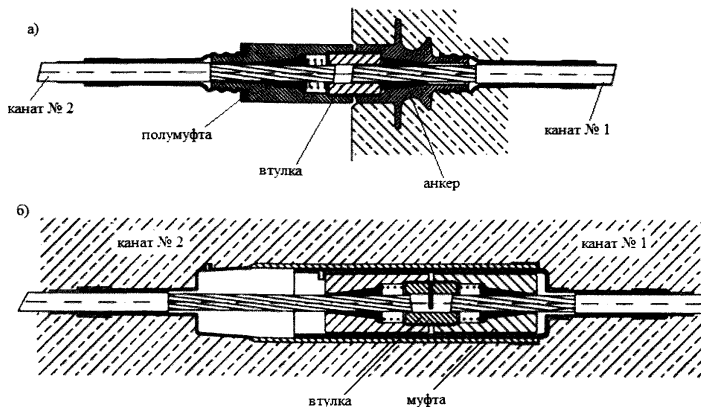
Конструкция муфт на примере технических решений фирмы «Дивидаг»
